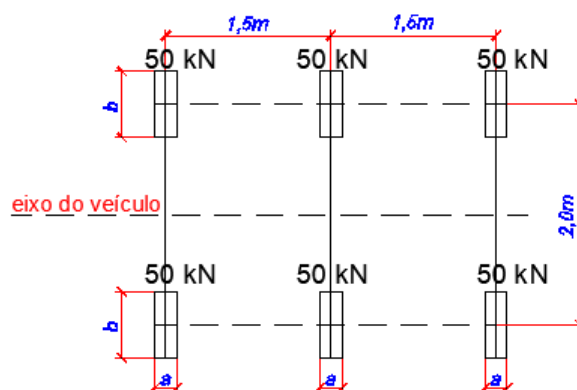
Vista em planta do veículo tipo classe II [RSA]
